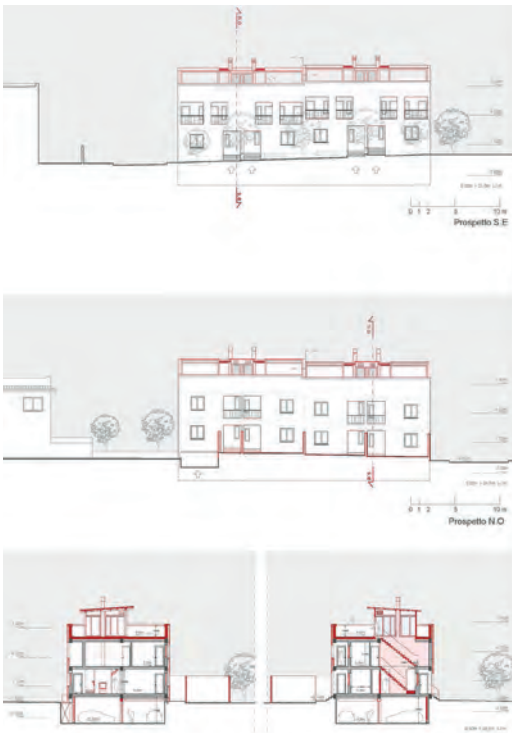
| Prospetti e sezioni di progetto (edificio A)
